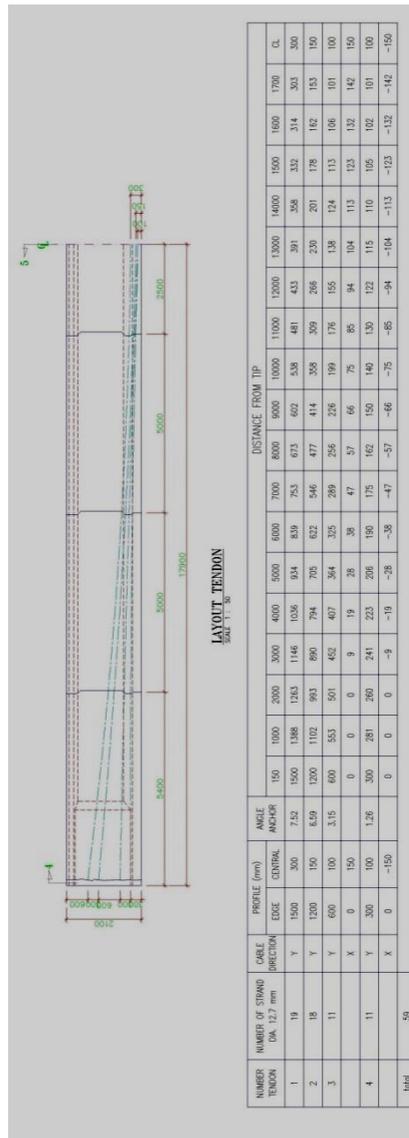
Gelagar balok PC-I girder Jembatan Air Dingin
